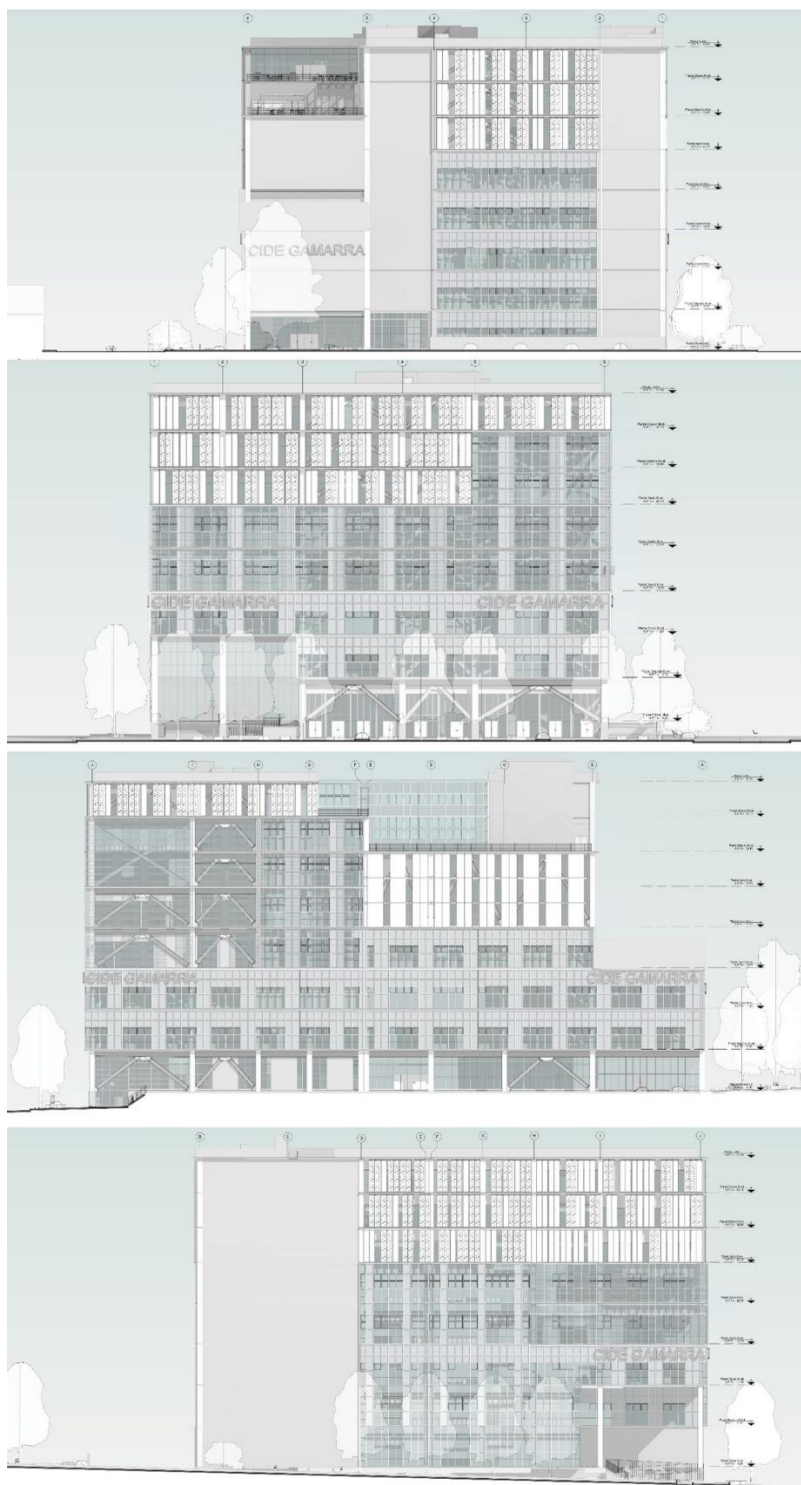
Vistas elevaciones norte, sur, este y oeste del proyecto. (de arriba hacia abajo).
